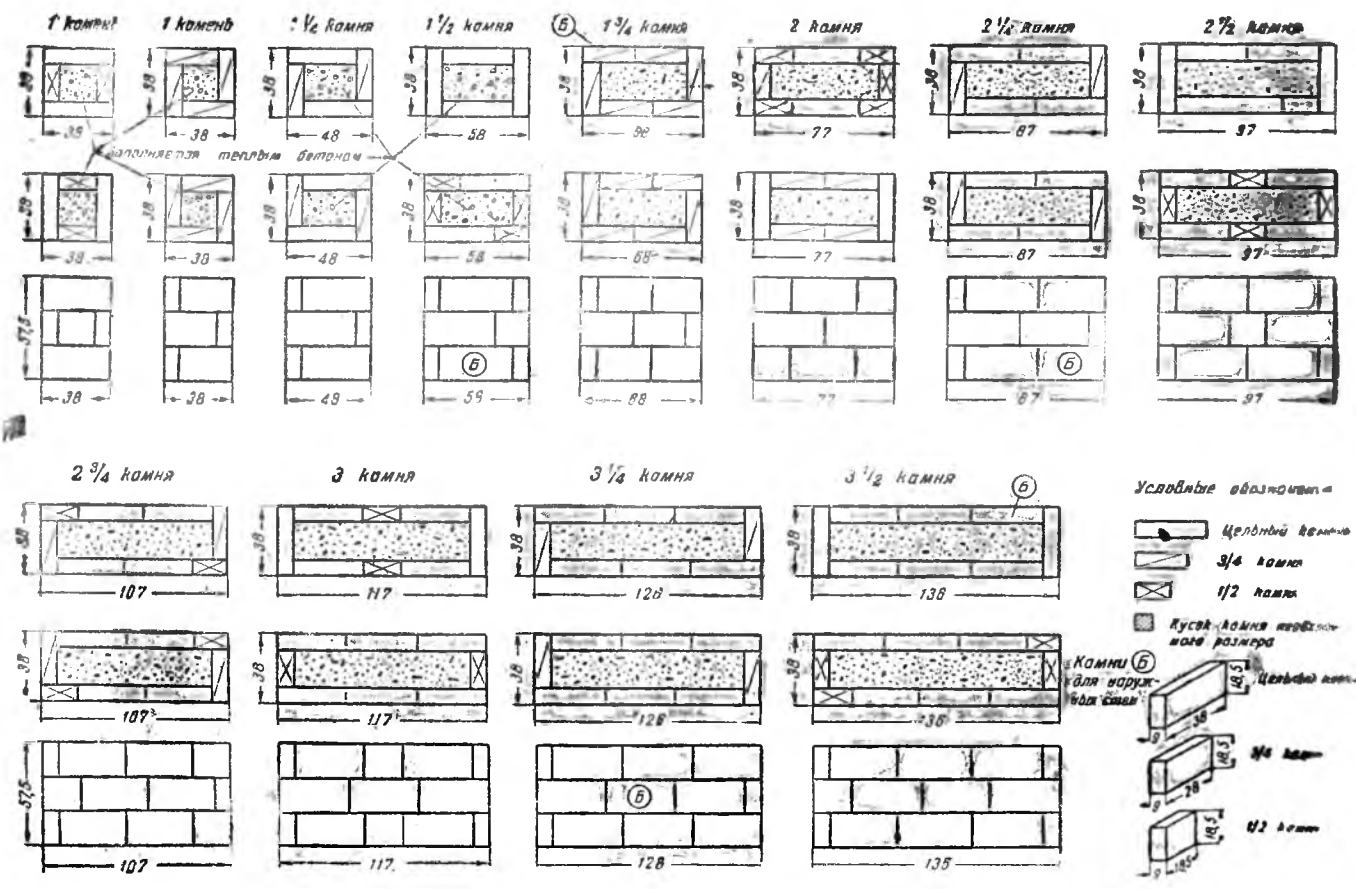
Засыпные стены из утоненных блоков. Кладка простенков
